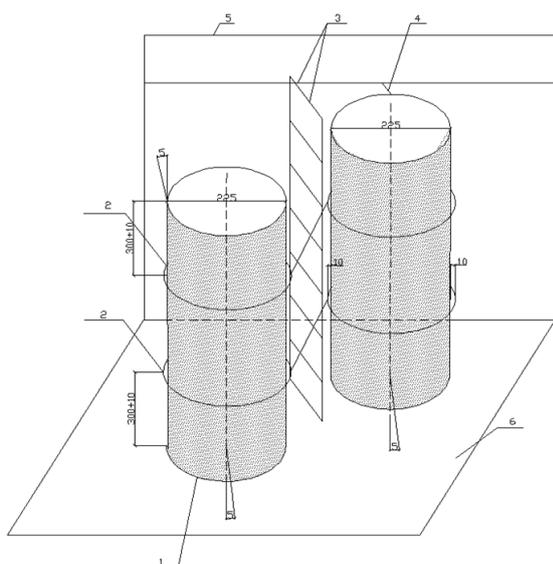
Эскиз монтажа пустотообразователей с выносной допускаемых отклонений: 1 – пустотообразователь; 2 – металлический каркас из арматуры диаметром 3мм; 3 – металлический каркас бетонируемой наружной конструкции стены; 4 – металлический фиксатор, обеспечивающий необходимое расстояние между пустотообразователями и щитами опалубки; 5 – палуба внутренней опалубки; 6 – основание установки пустотообразователей
